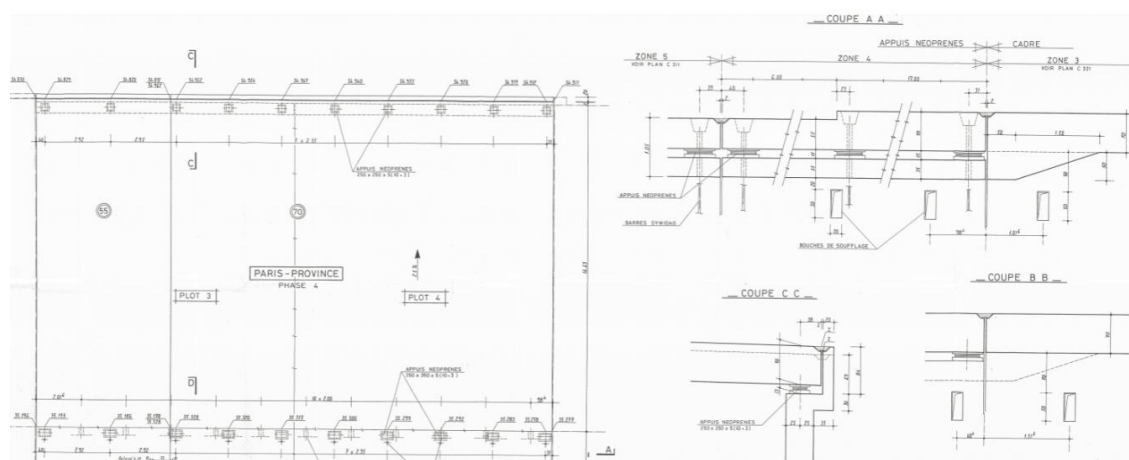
Vue en plan et coupes de détail des sections 4 à 7 sur appuis néoprènes intermédiaires et latéraux
